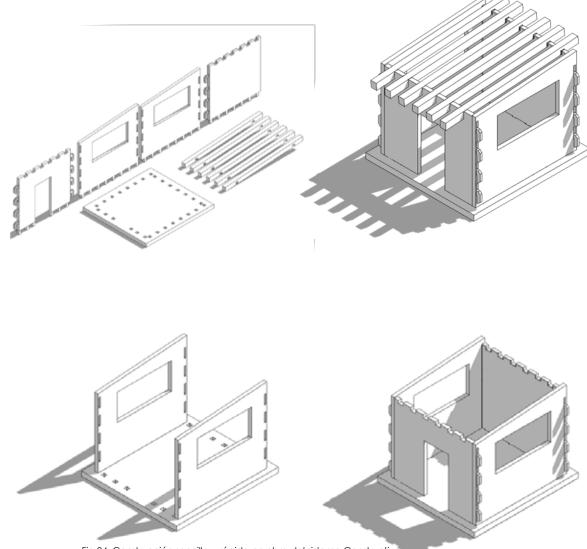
Construcción sencilla y rápida en obra del sistema Constructivo
